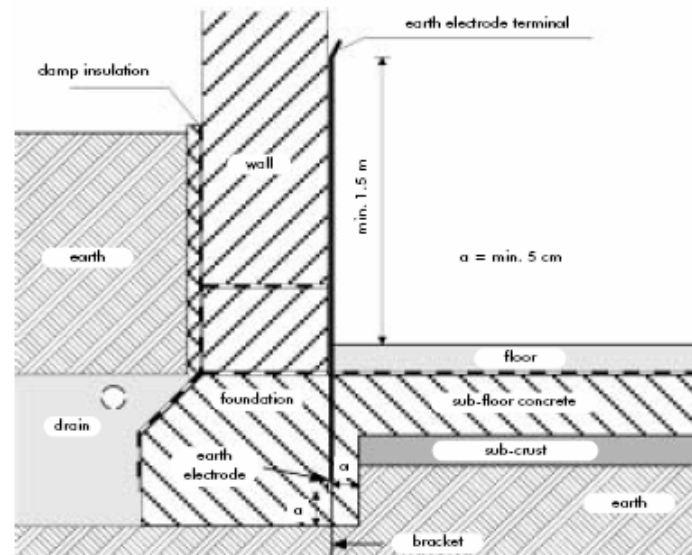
Electrode de terre dans des fondations sans béton armé
